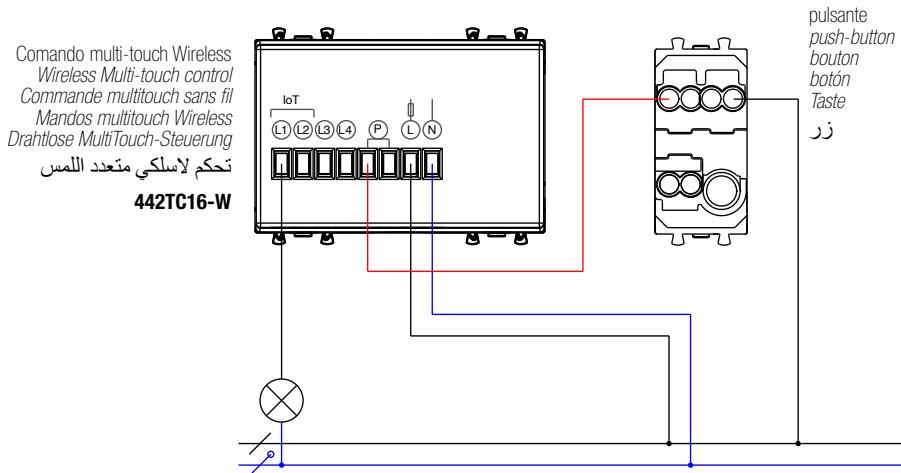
Schema di collegamento - Connection diagram - Schéma de connexion - Esquema de conexión - Anschlusschema - مخطط التركيب
